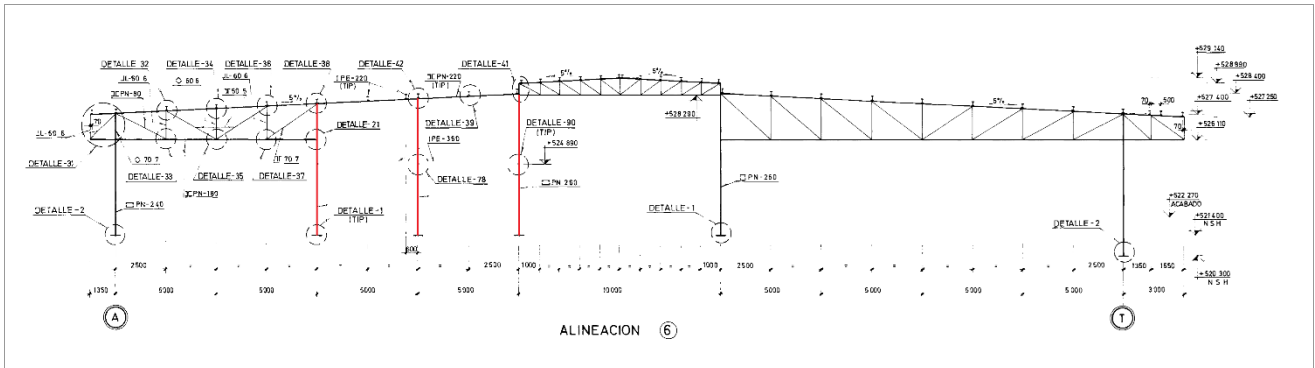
Estructura metálica – Modificación del pórtico en alineación 6
